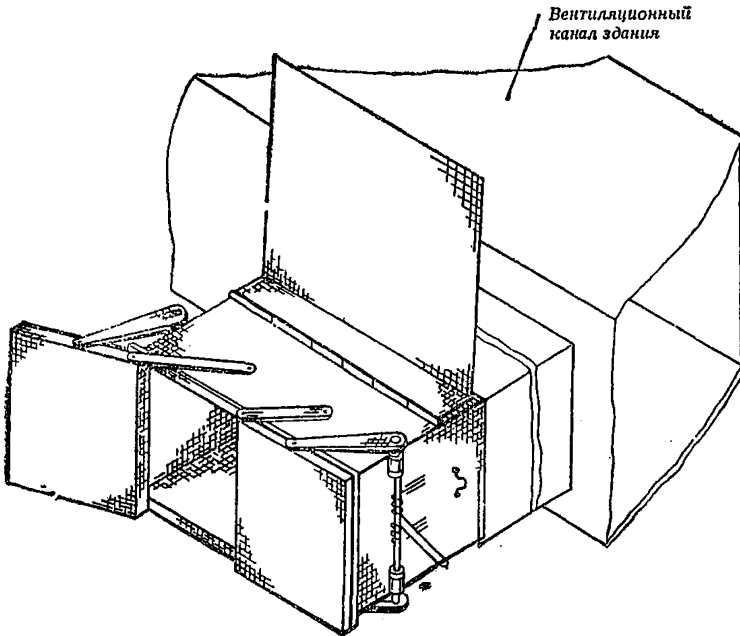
Универсальное приспособление для отвода отработавших газов от двигателя
